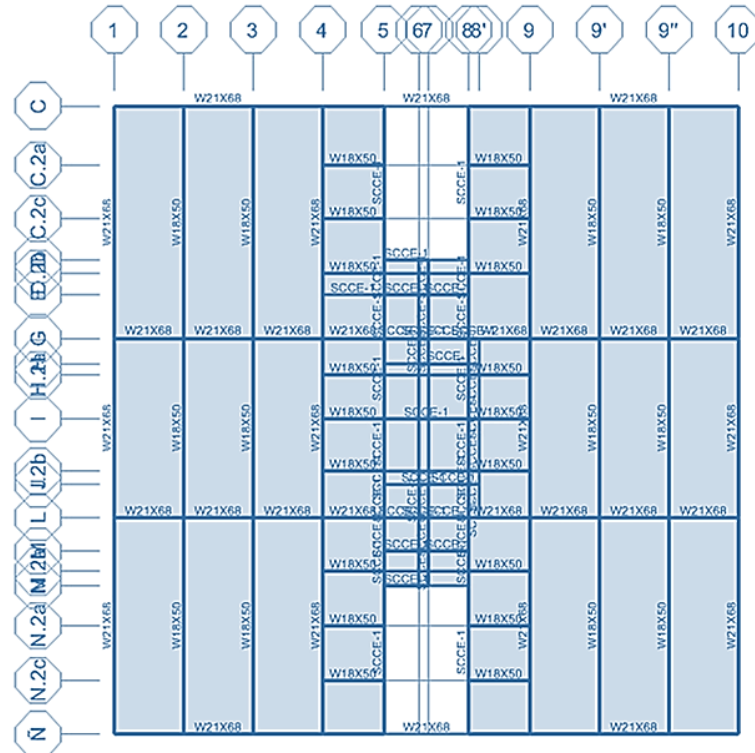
Vista de planta estructural desde piso11 al 15.
